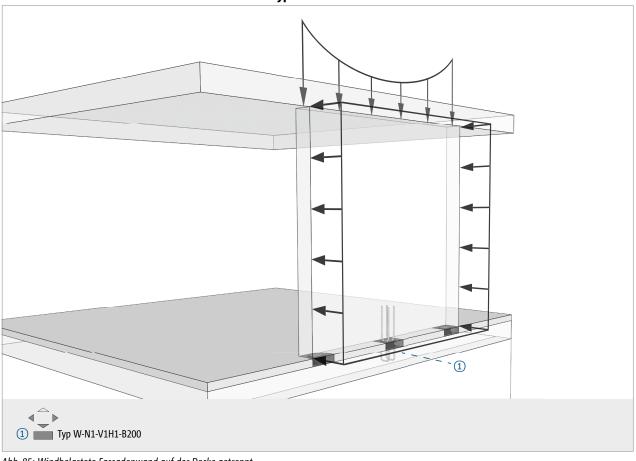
Windbelastete Fassadenwand auf der Decke getrennt
